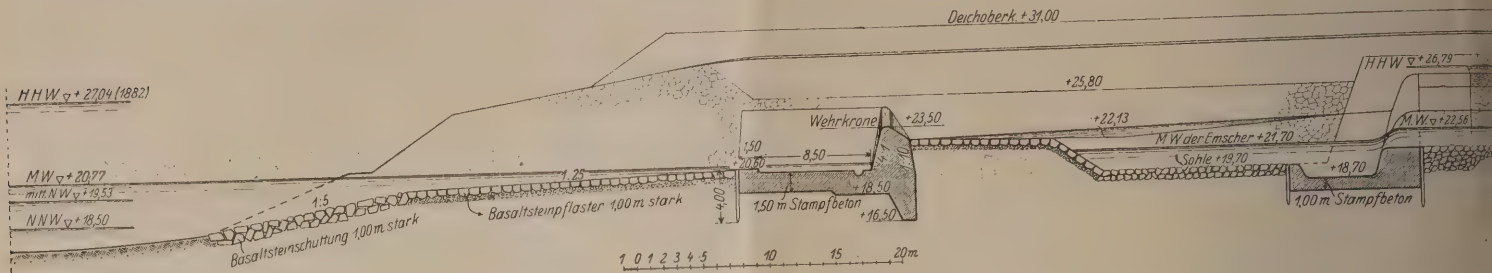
Längsschnitt durch den Hochwasserüberfall.
